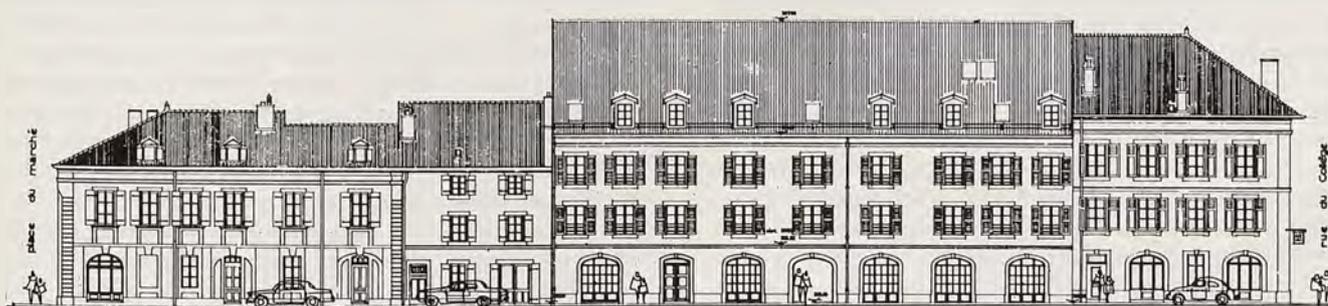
L'attuale prospetto su rue Jacques Dalphin.
